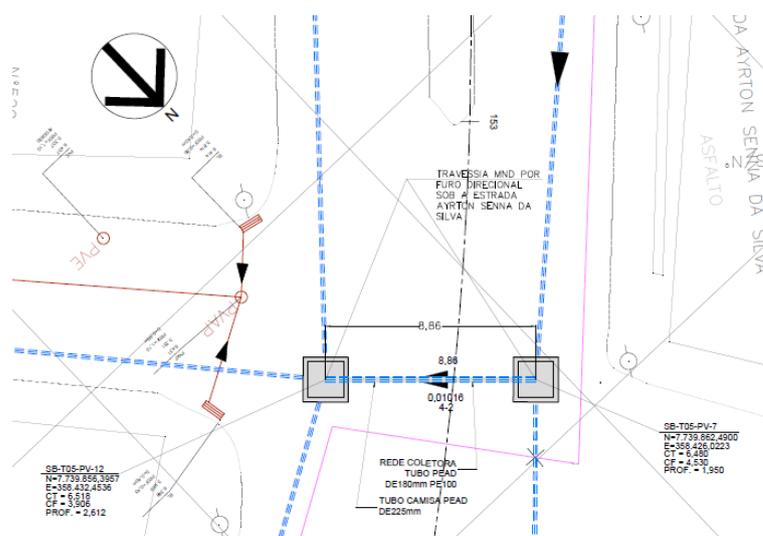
Planta de localização da travessia SB-T05 - PV-7 ao PV-12
